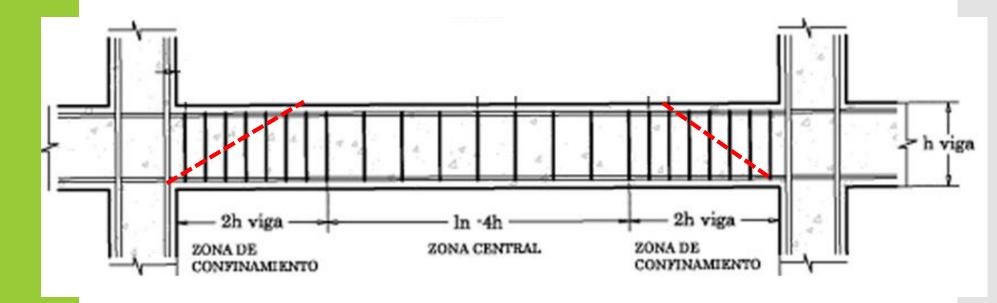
Modos potenciales de falla de vigas de concreto [IIT- MTPC, Earthquakes Tips, New Delhi]
